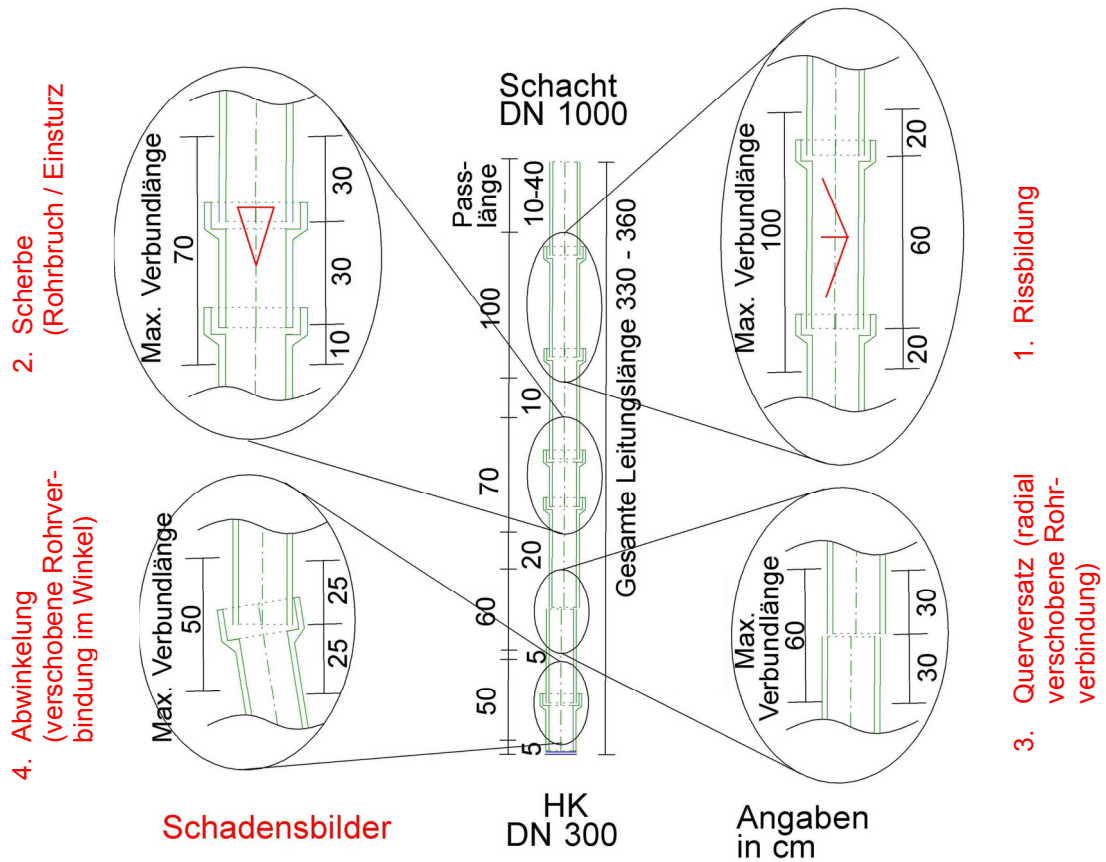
Versuchsaufbau Kurzliner: Untere Leitung (Testaufbau I)
